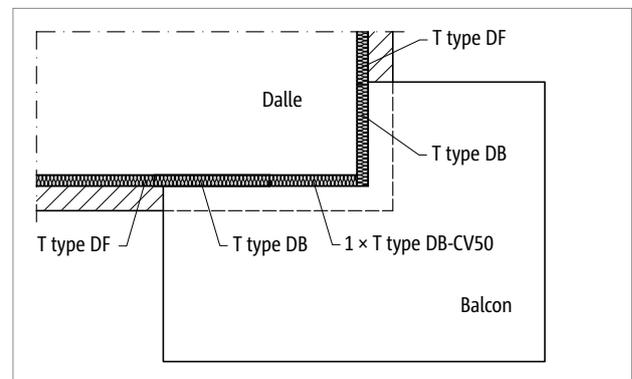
Schöck Rutherma® T type DB : balcon avec angle sortant en porte-à-faux et plancher constitué de prédalles
